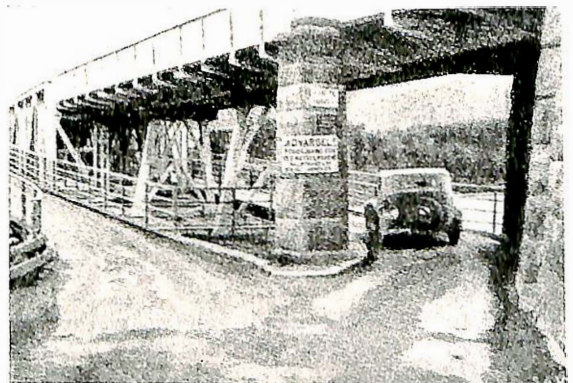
Enveisveier 2.20 m brede under jernbanebrua.
